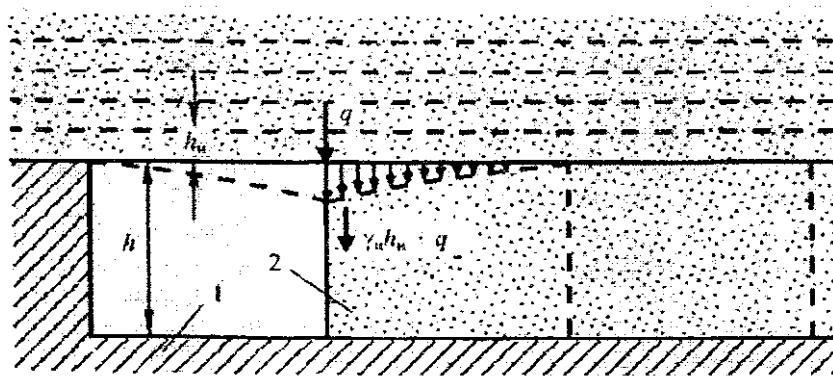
Схема нагружения закладочного массива стенки очистной выработки: 1 – руда; 2 – закладка
